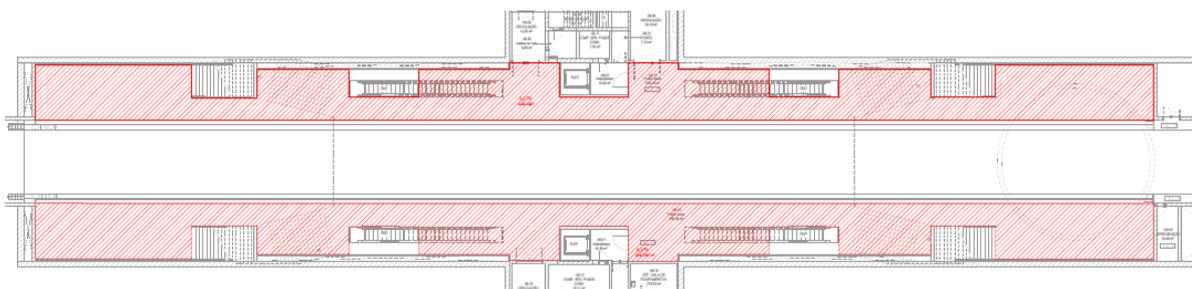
Estação Campo de Ourique, planta do Cais – determinação da área útil – Estação Campo de Ourique
